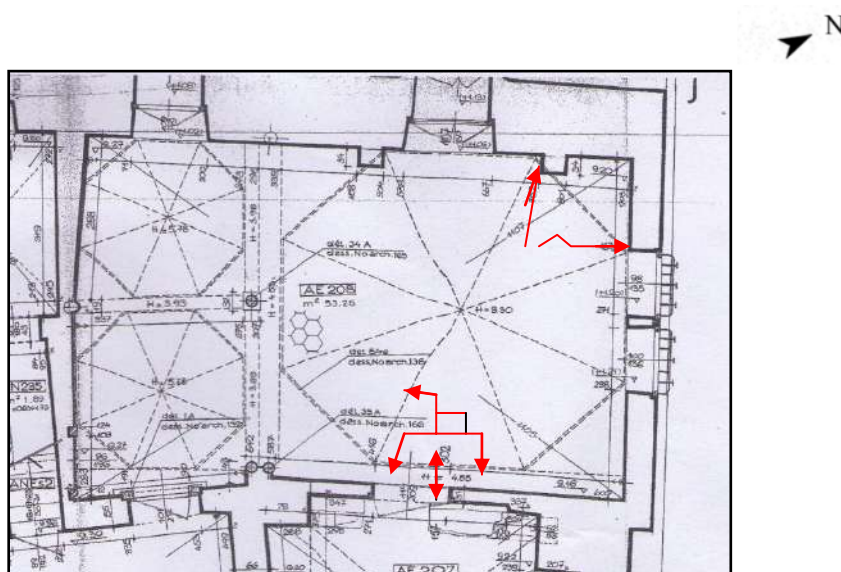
Plan du pavillon de musique, palais du Dey.
